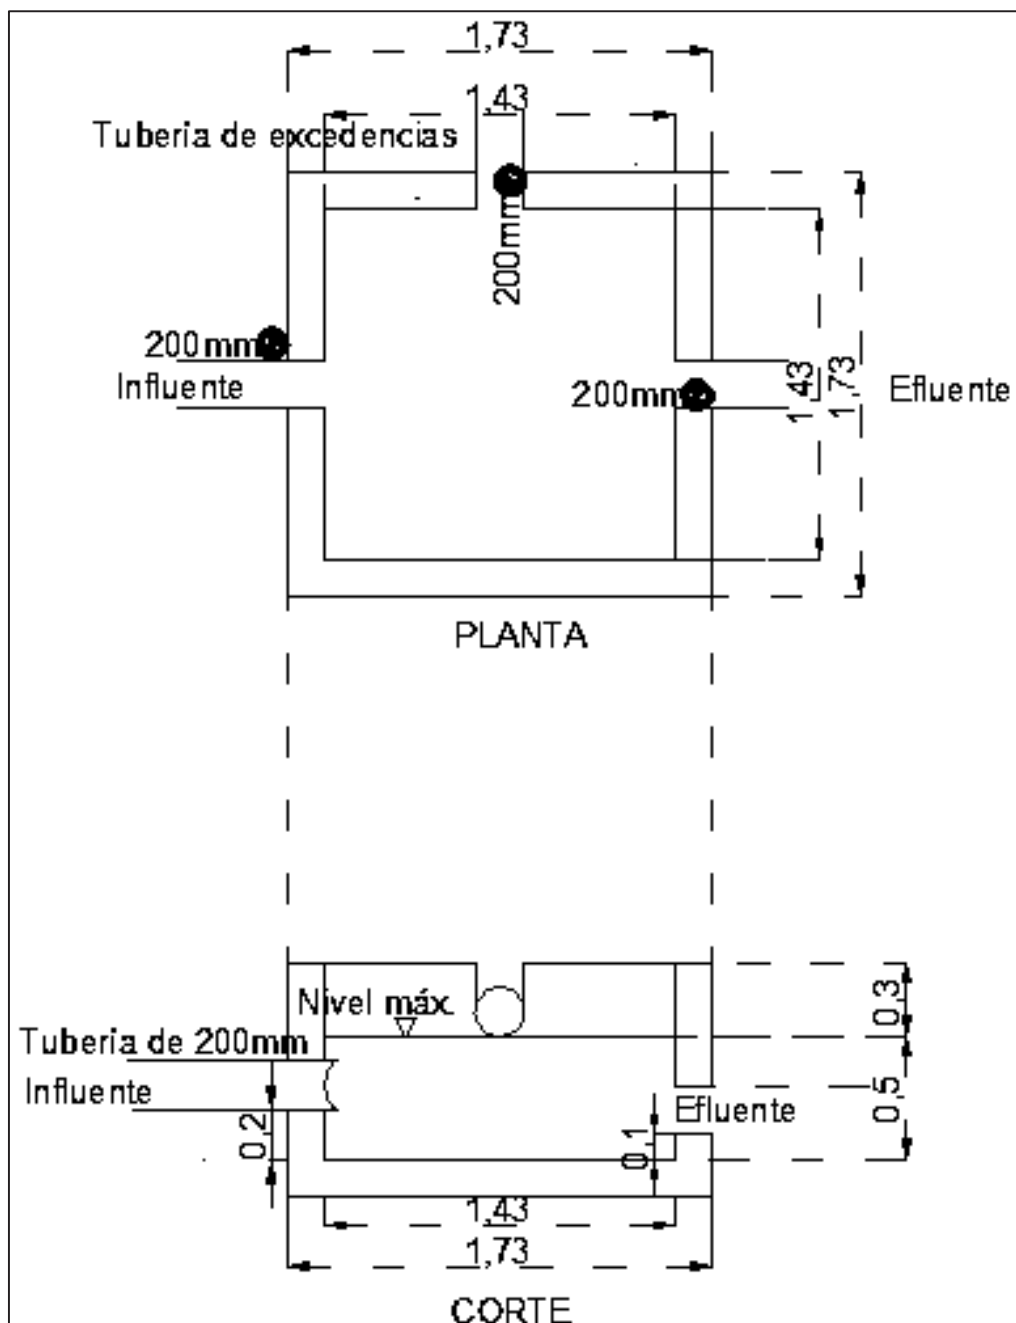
1Vista en planta y corte de caja de excedencias y desvío
